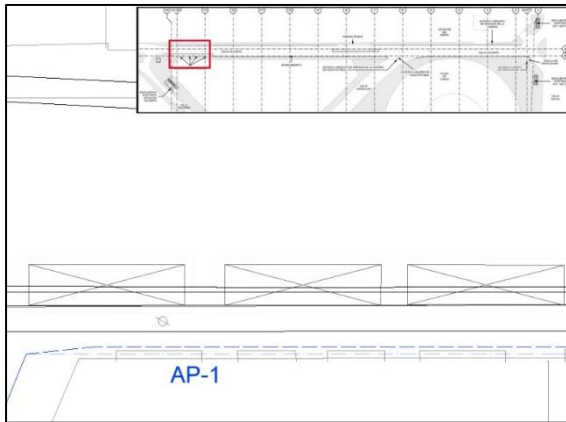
Plano de reposición AP-ALTA-AP1-SR-CX-F8. Zona inicial
